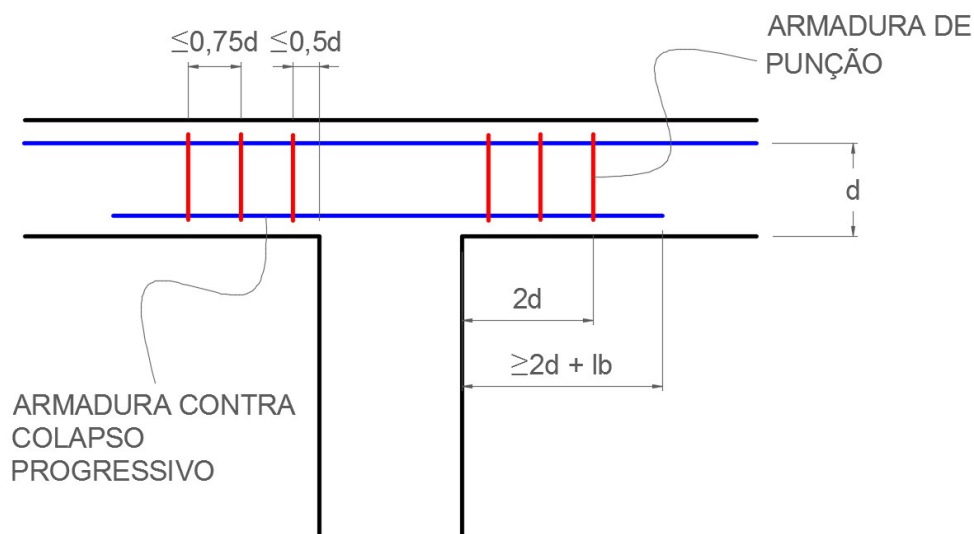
Disposição da armadura de punção e da armadura de colapso progressivo
